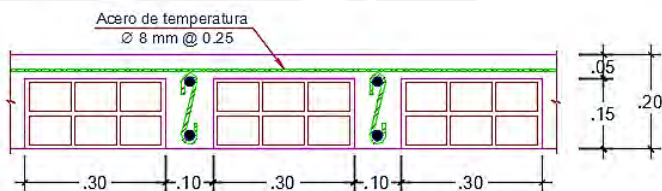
DETALLE TÍPICO DE ALIGERADO H = 20 CM.
